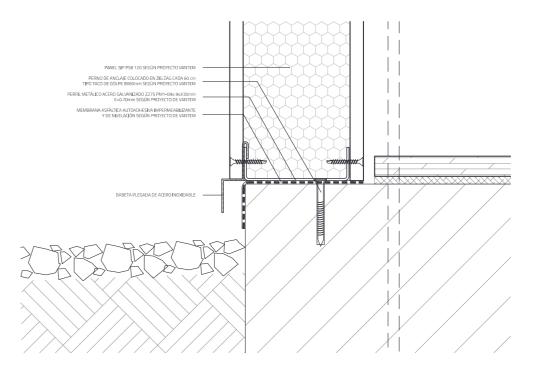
, DETALLE 5: FIJACIÓN DE PANELES A CONTRAPISO.
